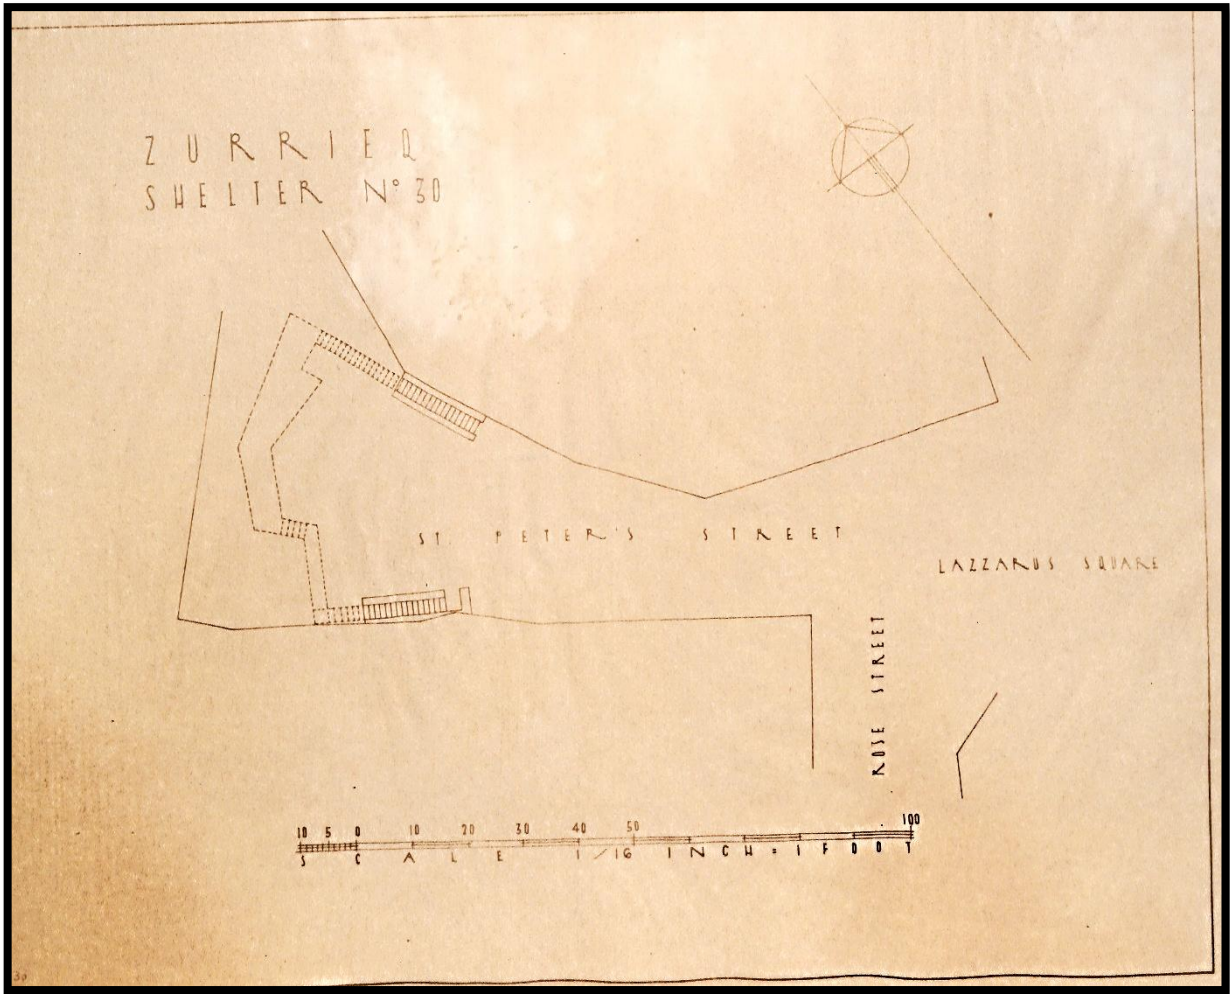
Planta do Abrigo nº 30 "St. Peter's Street – Rose Street – Lazzarus Square."
